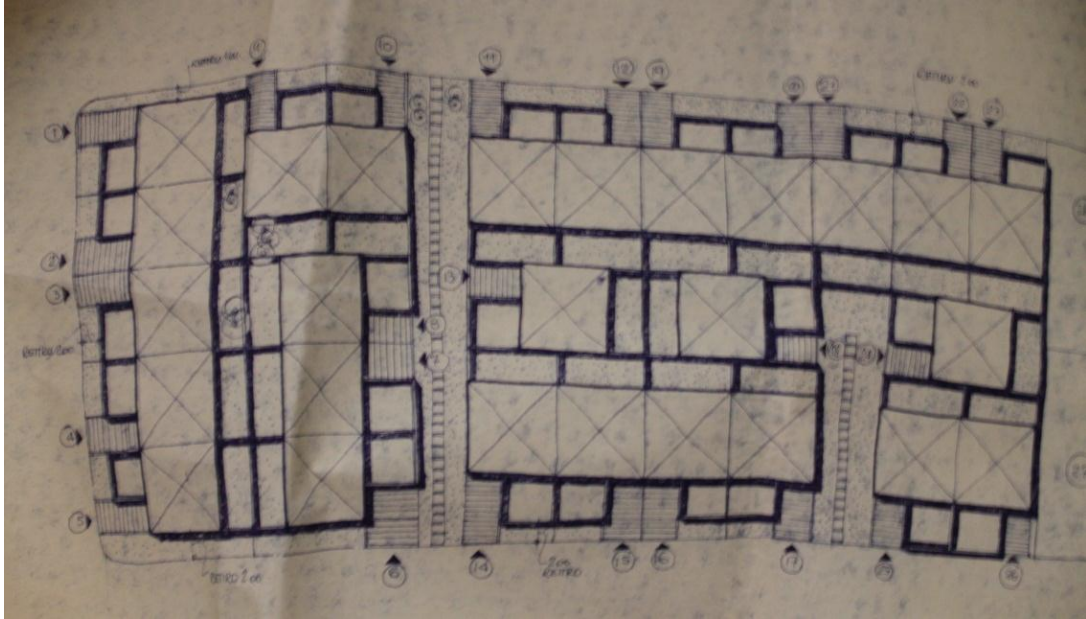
Plano original de manzaneo y distribución de viviendas
